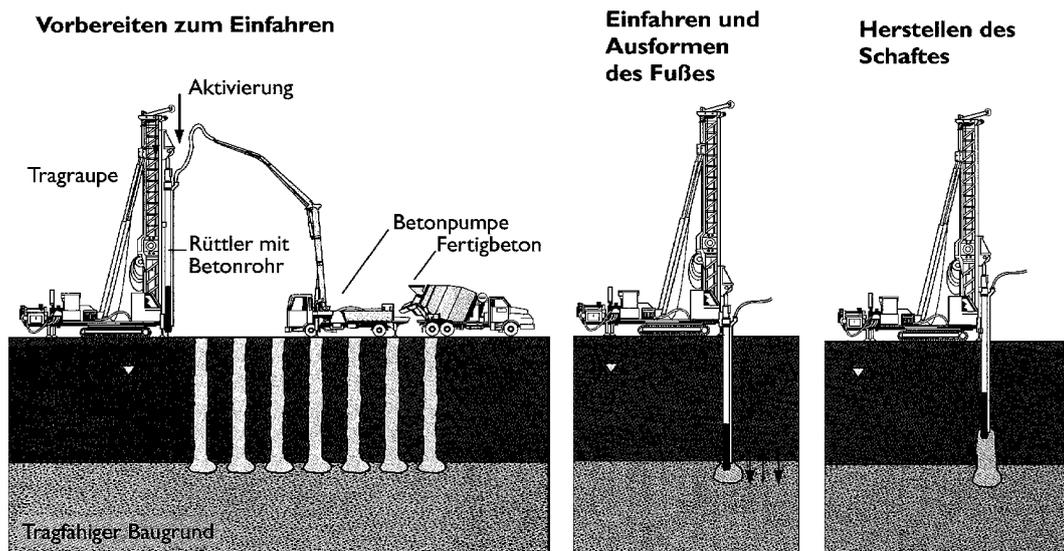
Herstellungsvorgang FSS-Betonrüttelsäulen mit Lieferbeton [7]
